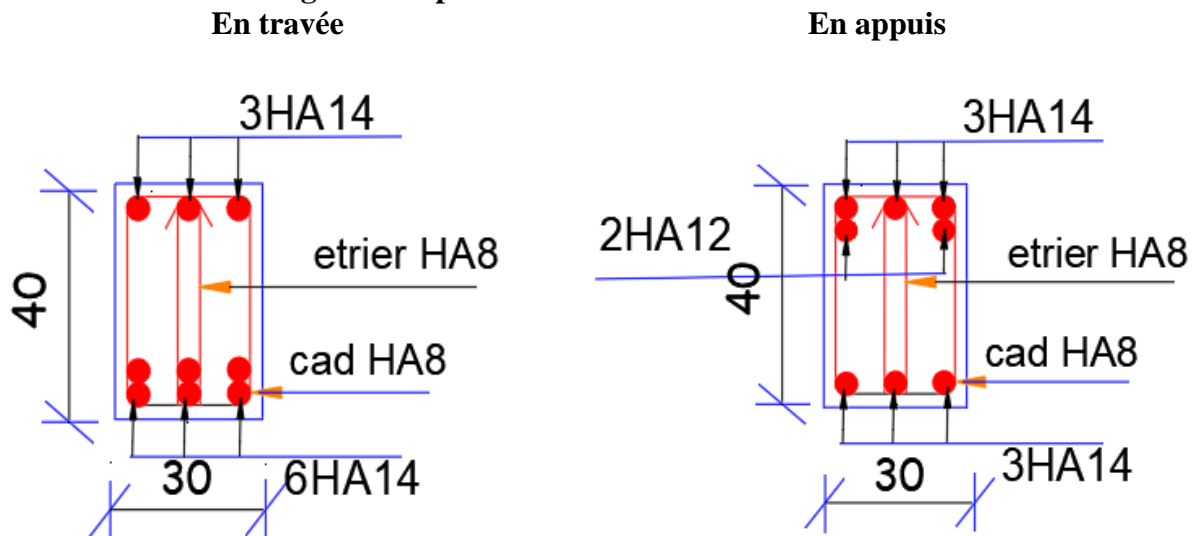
Schéma de ferrailage de la poutre brisée.
